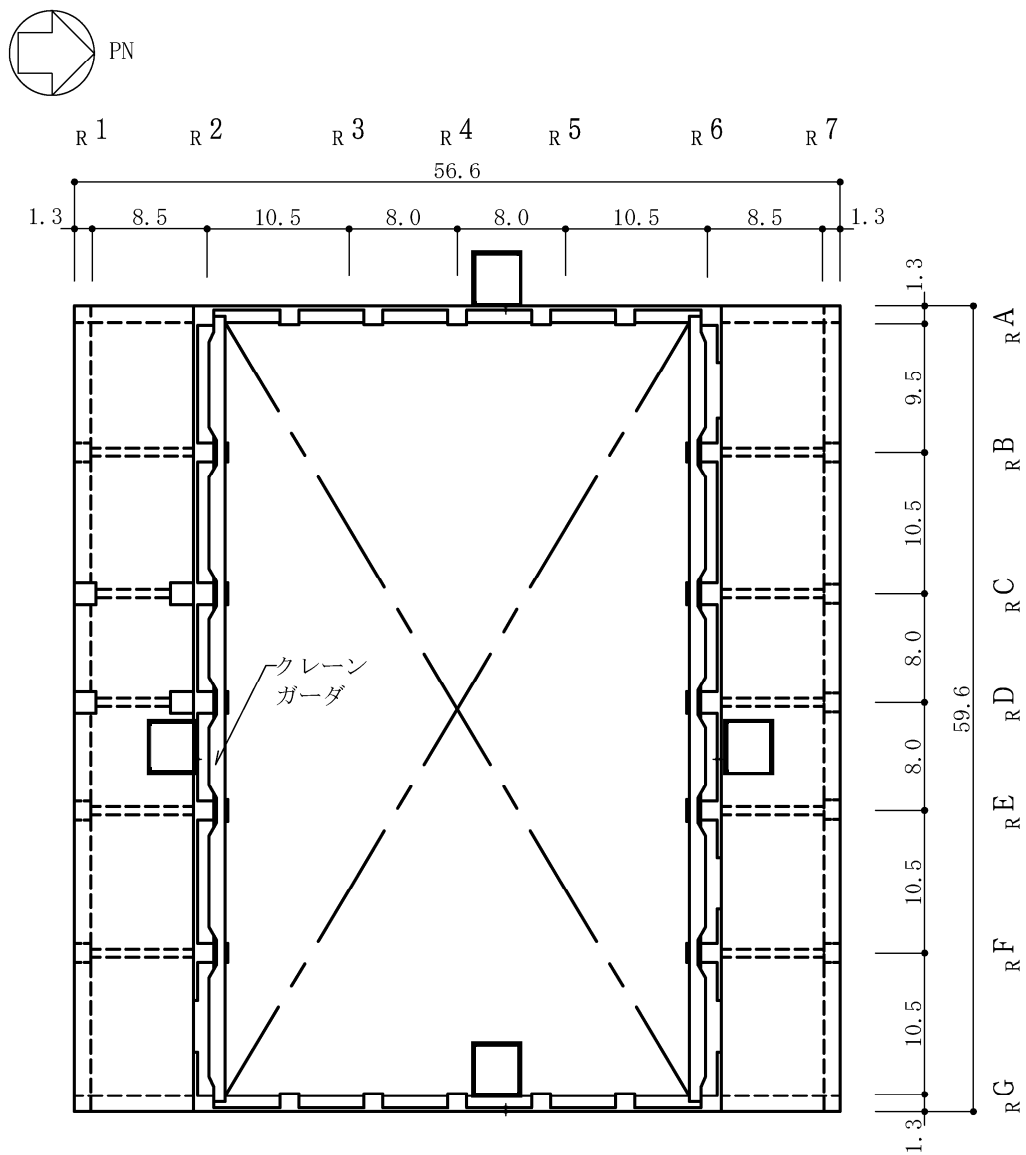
原子炉建屋の概略平面図 (CRF, T.M.S.L. 38.2m) (単位 : m) (8/9)
